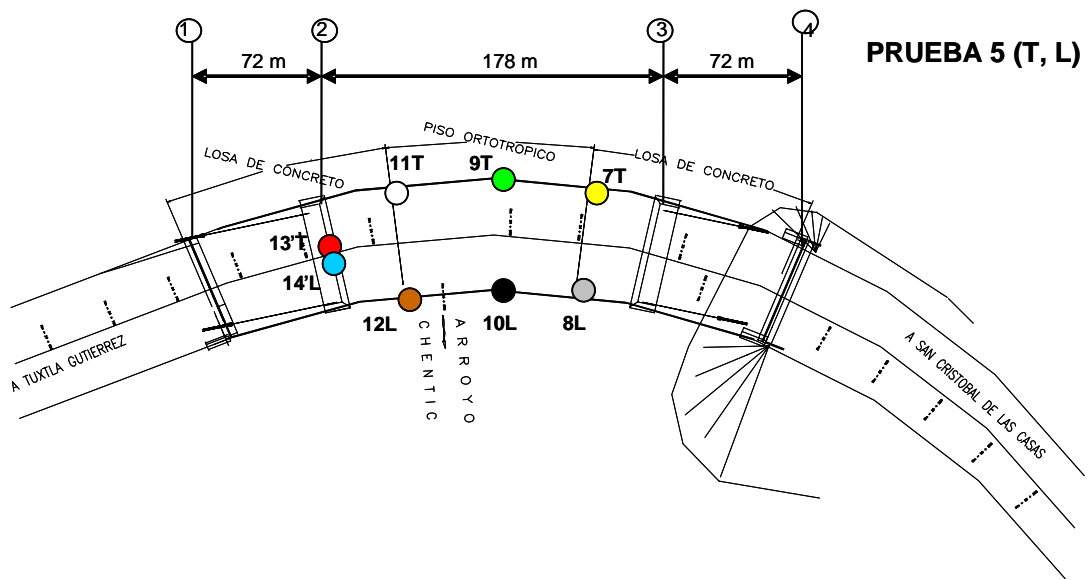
Prueba 5 en dirección trasversal y longitudinal
